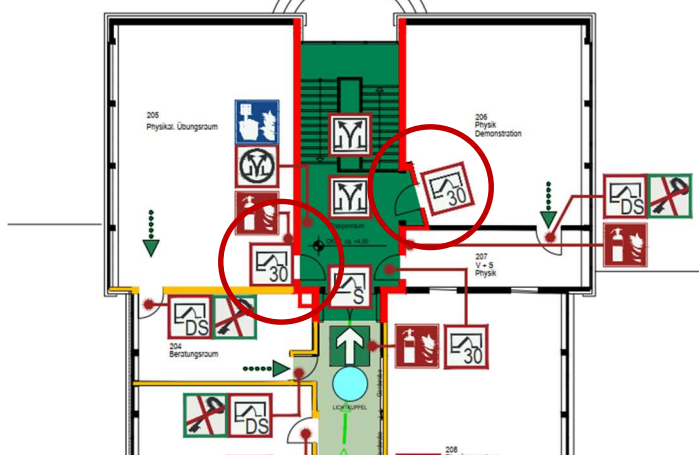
Planausschnitt Obergeschoss (Brandschutzkonzept vom 02.11.22)
